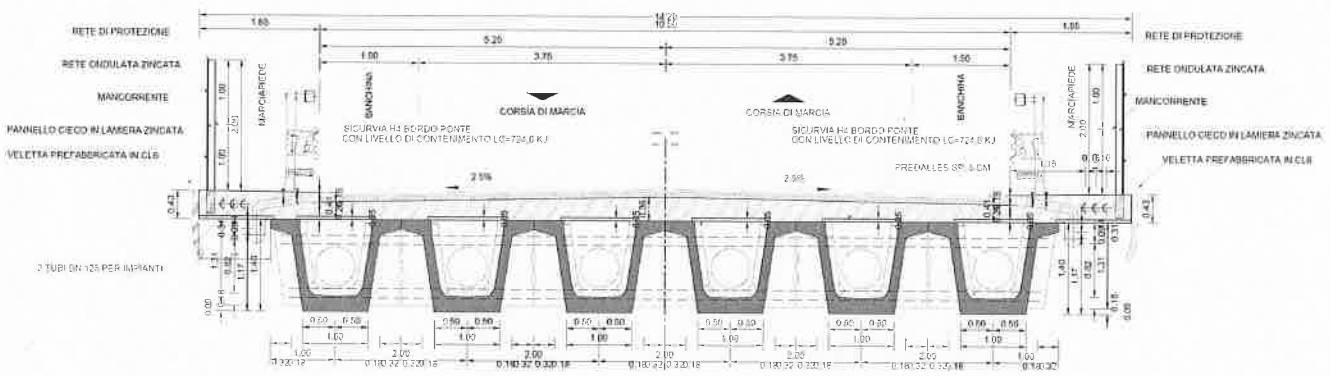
Sezione Tipo Cavalferrovia impalcato da 25 m
